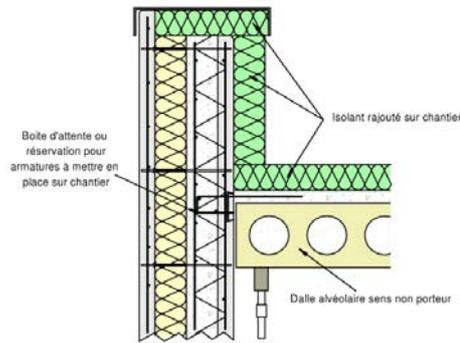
Dalle alvéolaire avec acrotère - Sens non porteur
